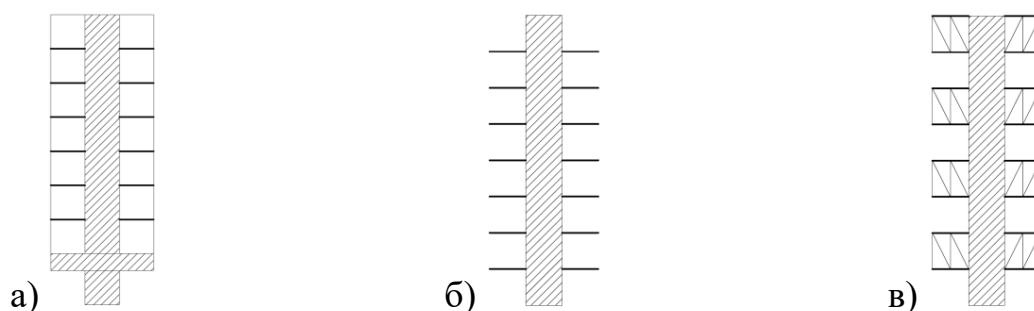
Здания ствольно-консольной конструктивной системы: а) с консольным поясом в уровне нижних этажей; б) с консольными перекрытиями в уровне каждого этажа; в) с консолями высотой на этаж в уровне каждого второго этажа
